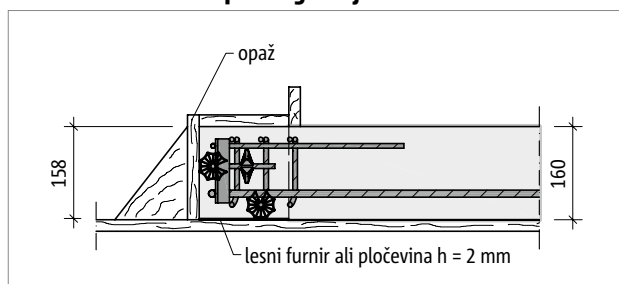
Schöck Tronsole® tip Z: stenski element kot izgubljeni opaž; spodnja stran podesta je nižje kot priključni okvir stenskega elementa
